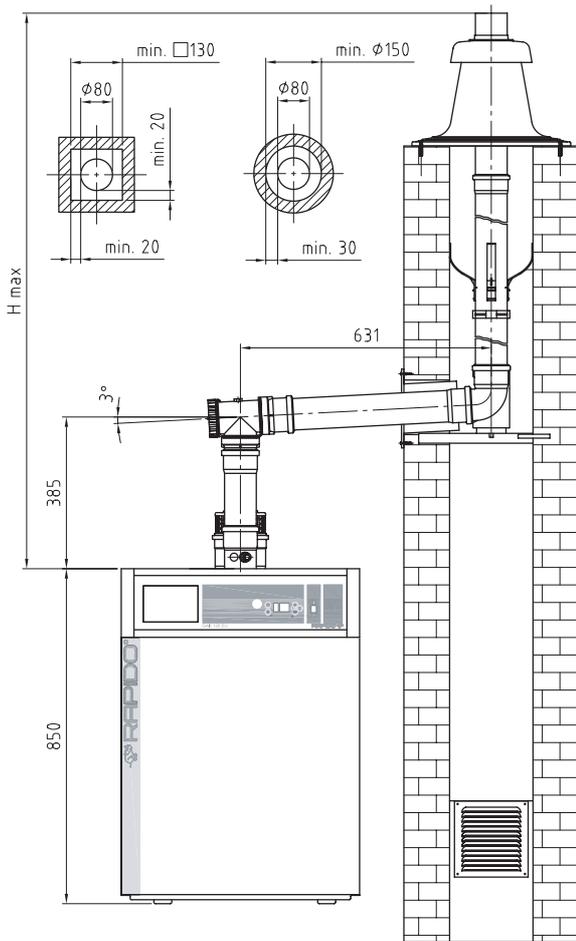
Raumluftabhängige Abgasführung im Schacht
